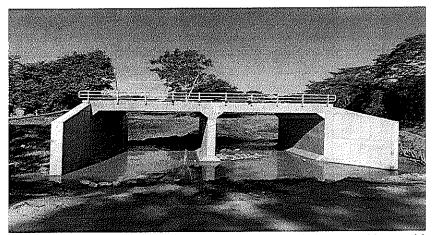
Estructura box culvert construida en el sitio autorizado de la ocupación, sentido aguas abajo del Río Magiriaimo.
